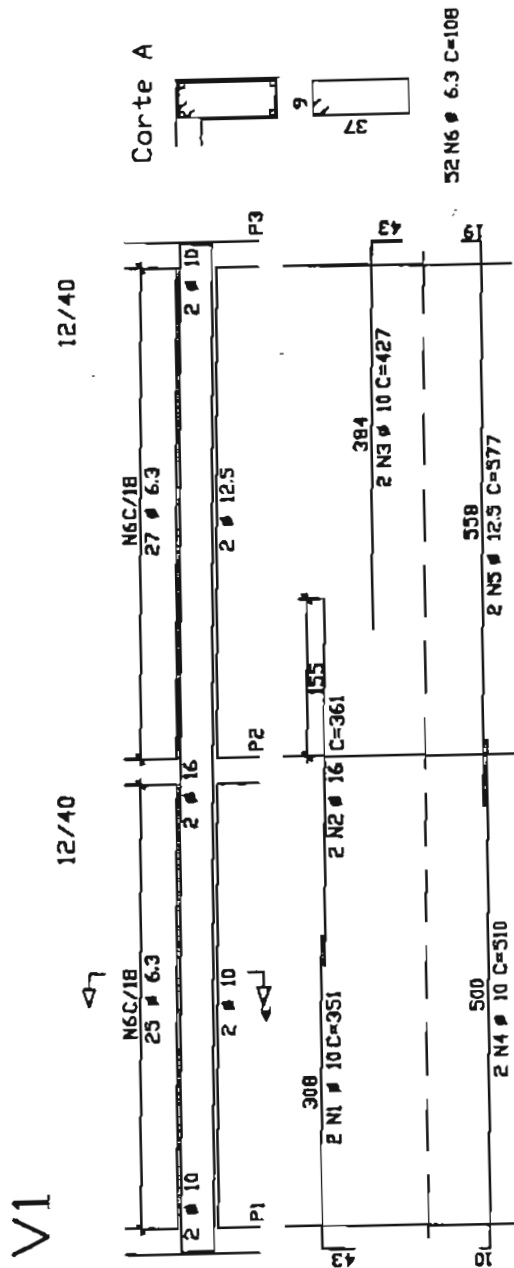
Detalhe de armadura da viga V1 (pórtico simplificado)
